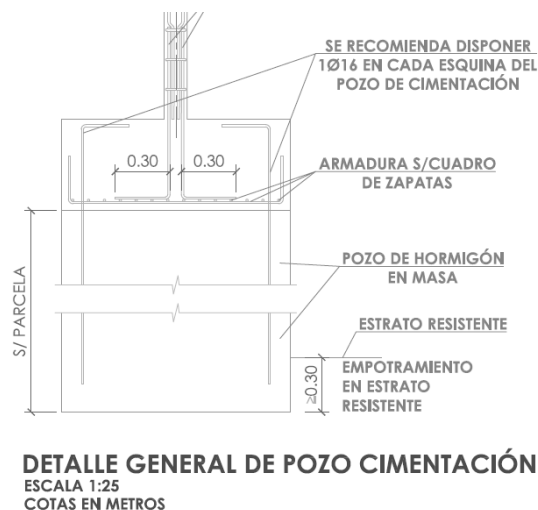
Detalle tipo pozo de hormigón bajo zapata
